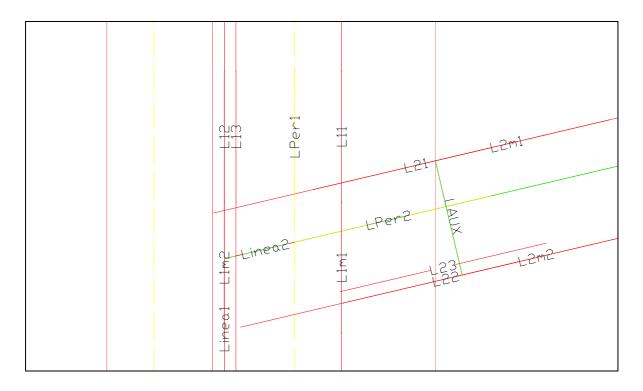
Líneas Dibujadas para Construcción de Unión de Planchas
